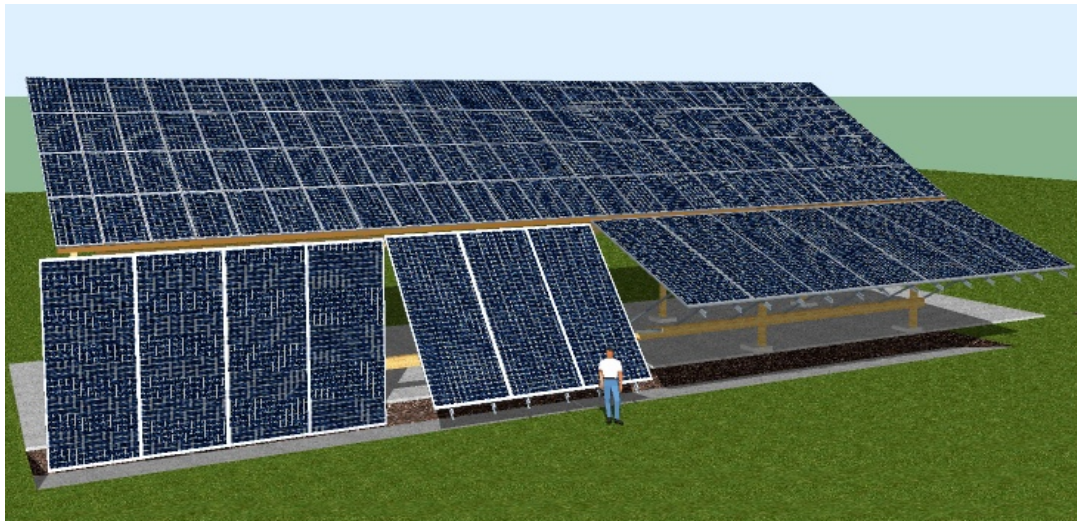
kWp Photovoltaikhalle mit Dach und Fassadenanlage, die der Sonne nachgestellt wird.
